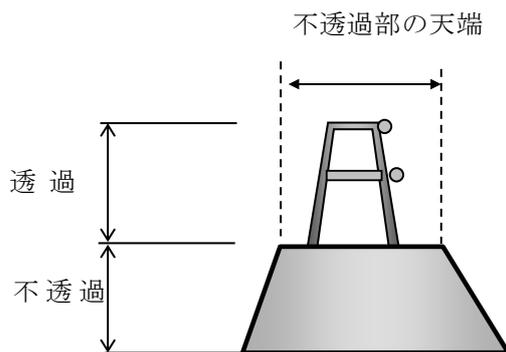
部分透過型砂防堰堤越流部側面図 (例)
